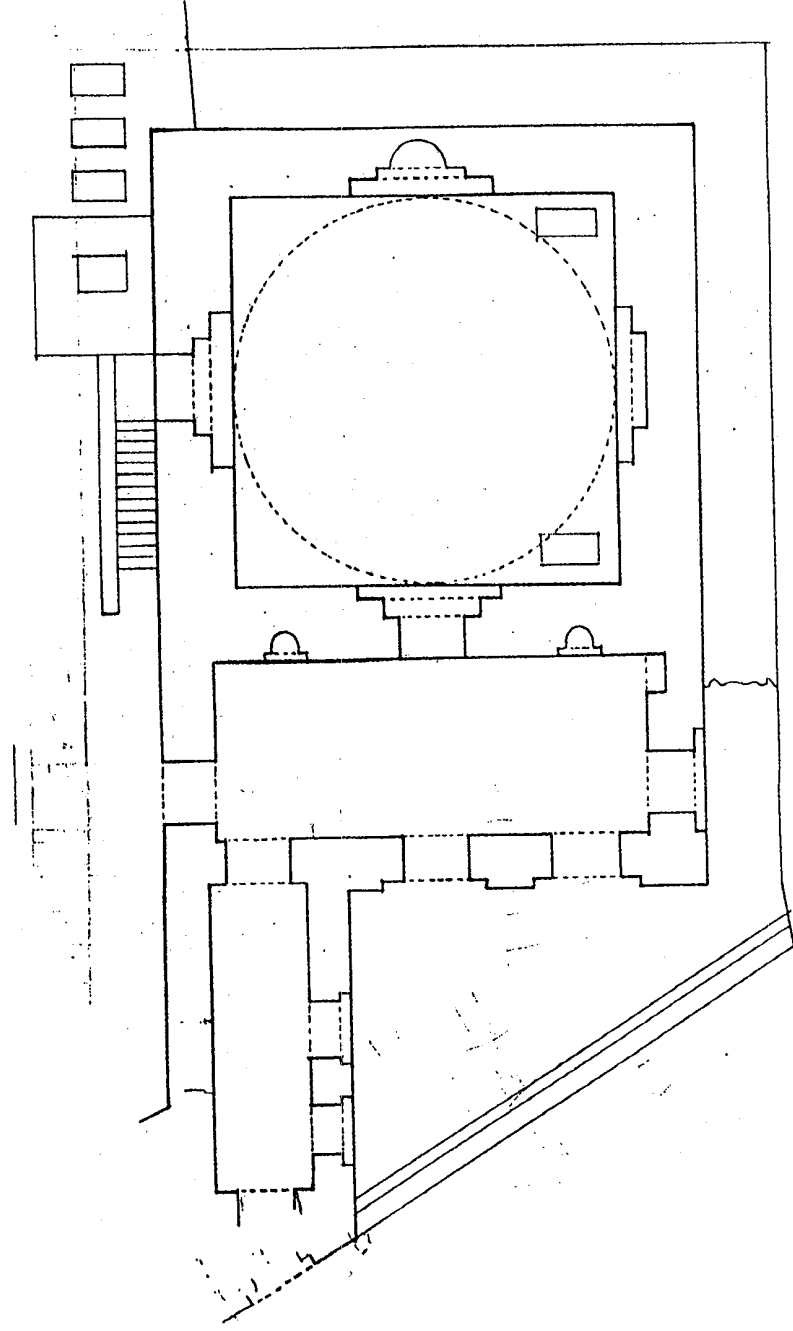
مسقط أفقي لجامع داود باشا في استانبول (عن Goodwin)
